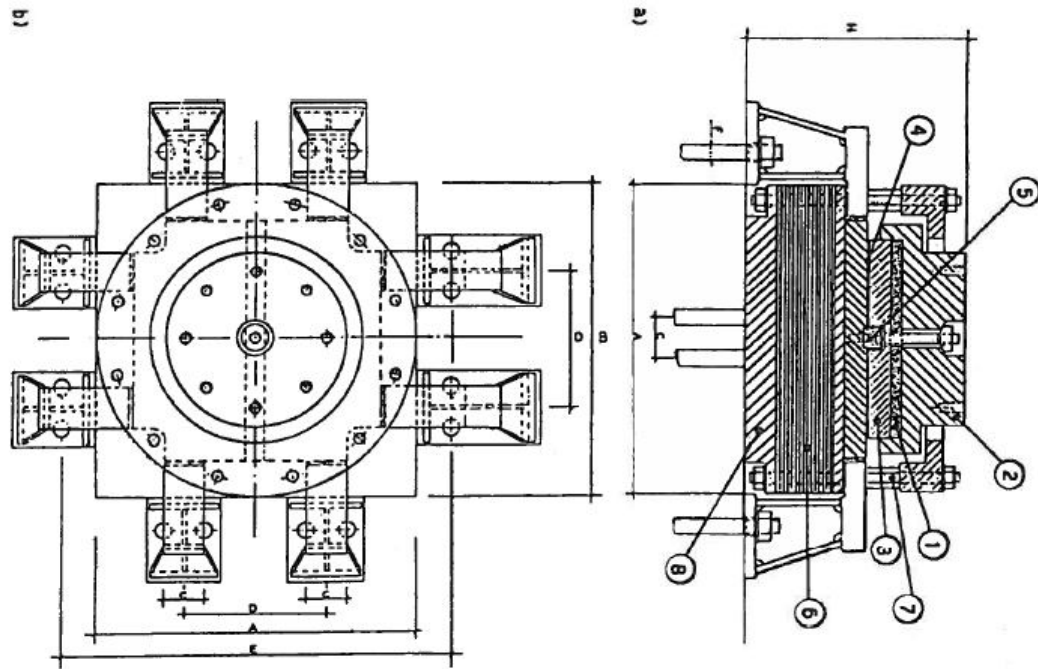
Schema esemplificativo dell'apparecchio di appoggio
